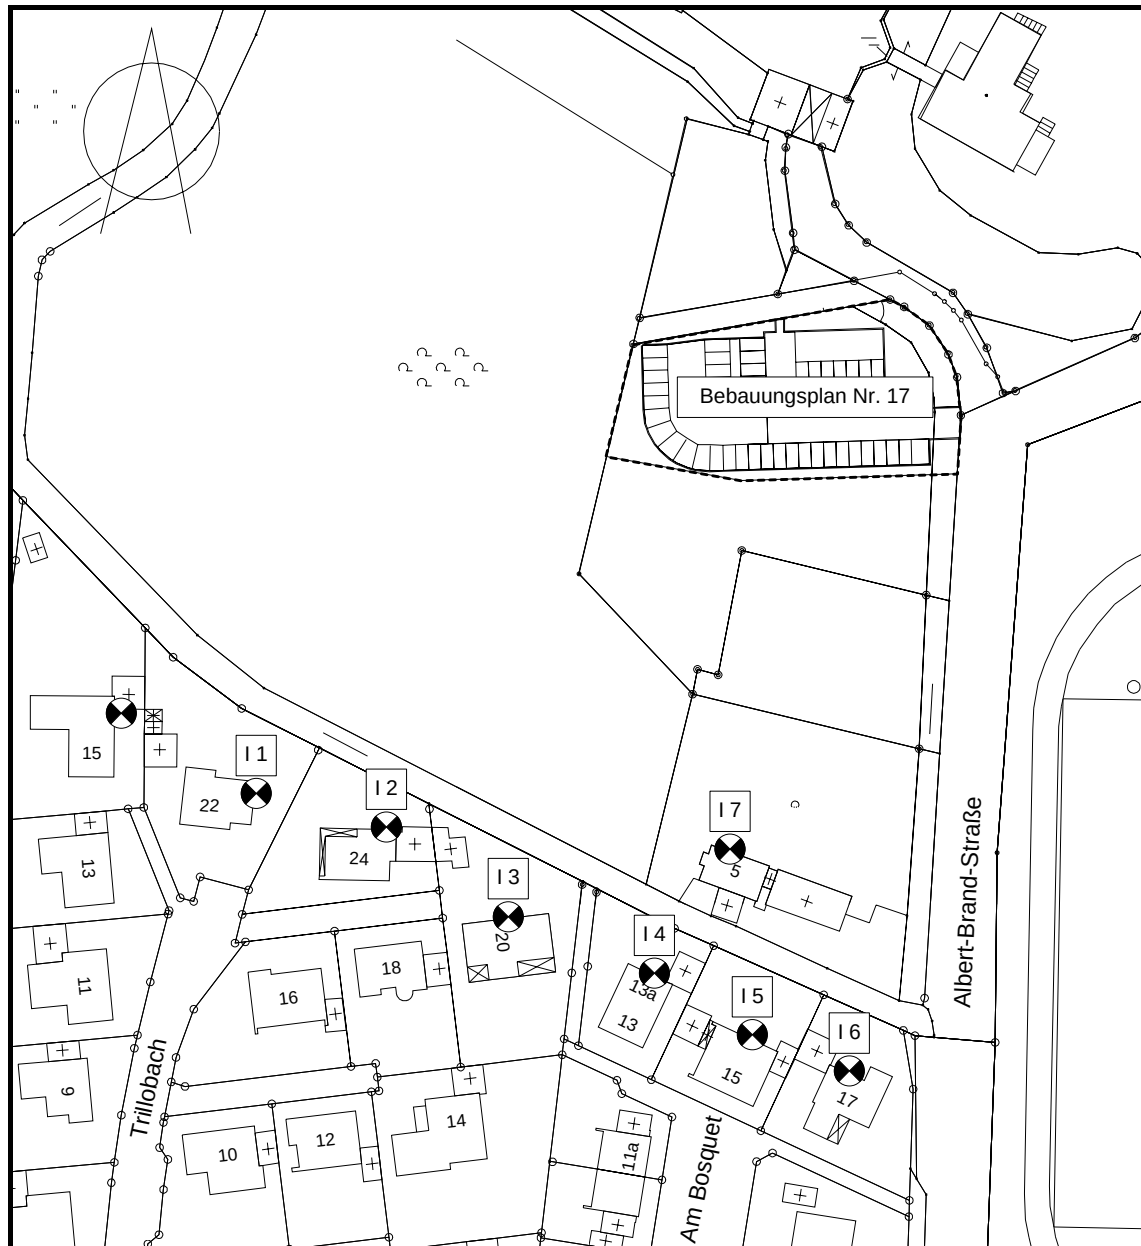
Lageplan Gebäude und Immissionsorte, Maßstab 1:1500
